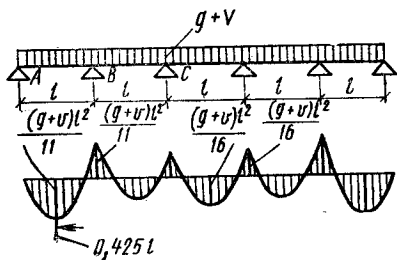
К расчету неразрезной плиты и второстепенных балок
